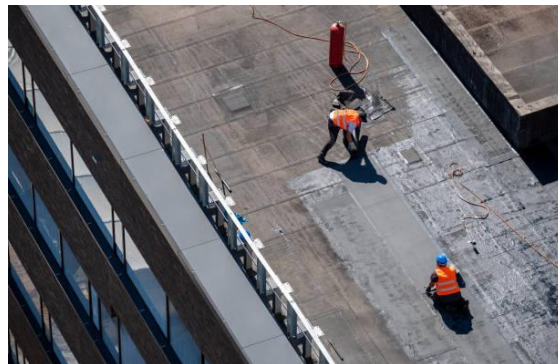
Impermeabilizante. iStock. (n.d.). Impermeabilizantes fotografía3s de stock. Recuperado de <https://www.istockphoto.com/es/fotos/impermeabilizante>
